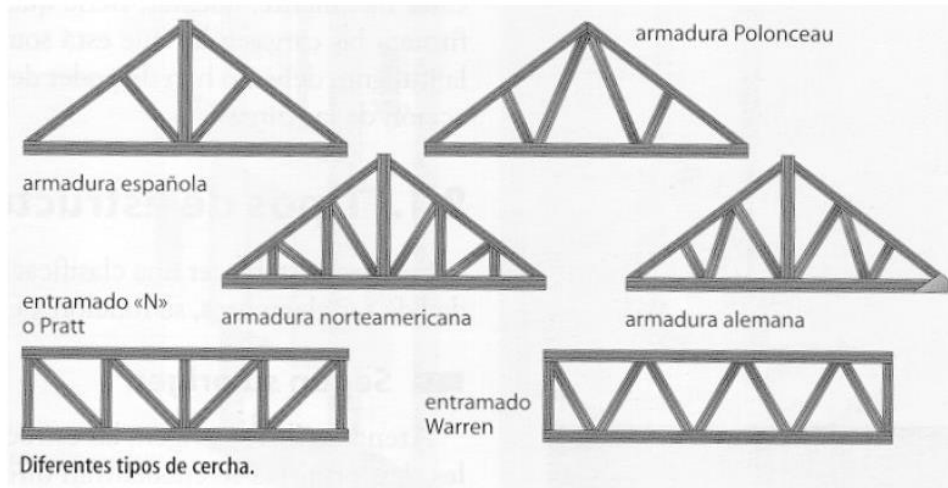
Diferentes tipos de cerchas para un pórtico.
